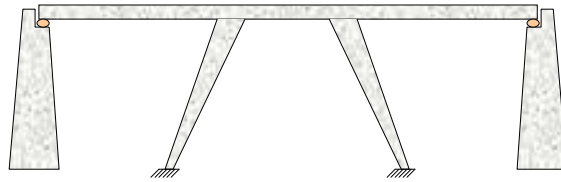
Puente aporticado de sección constante o variable y diferentes condiciones de apoyo con columnas inclinadas
